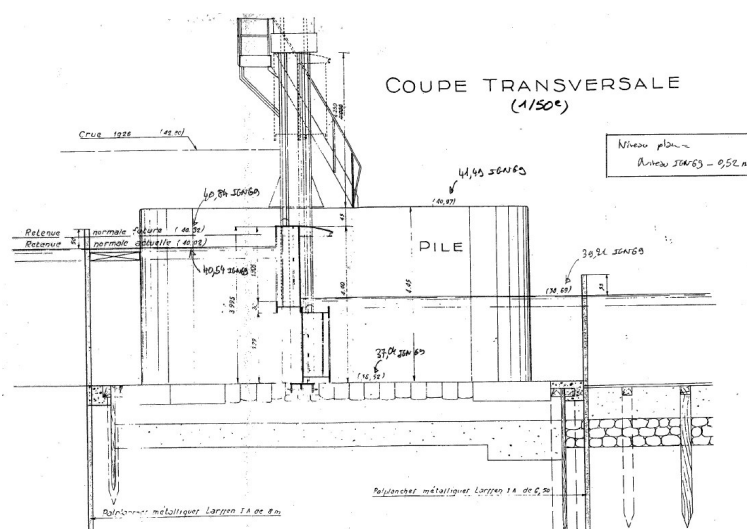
Coupe transversale dans le pertuis (plan de 1961)
